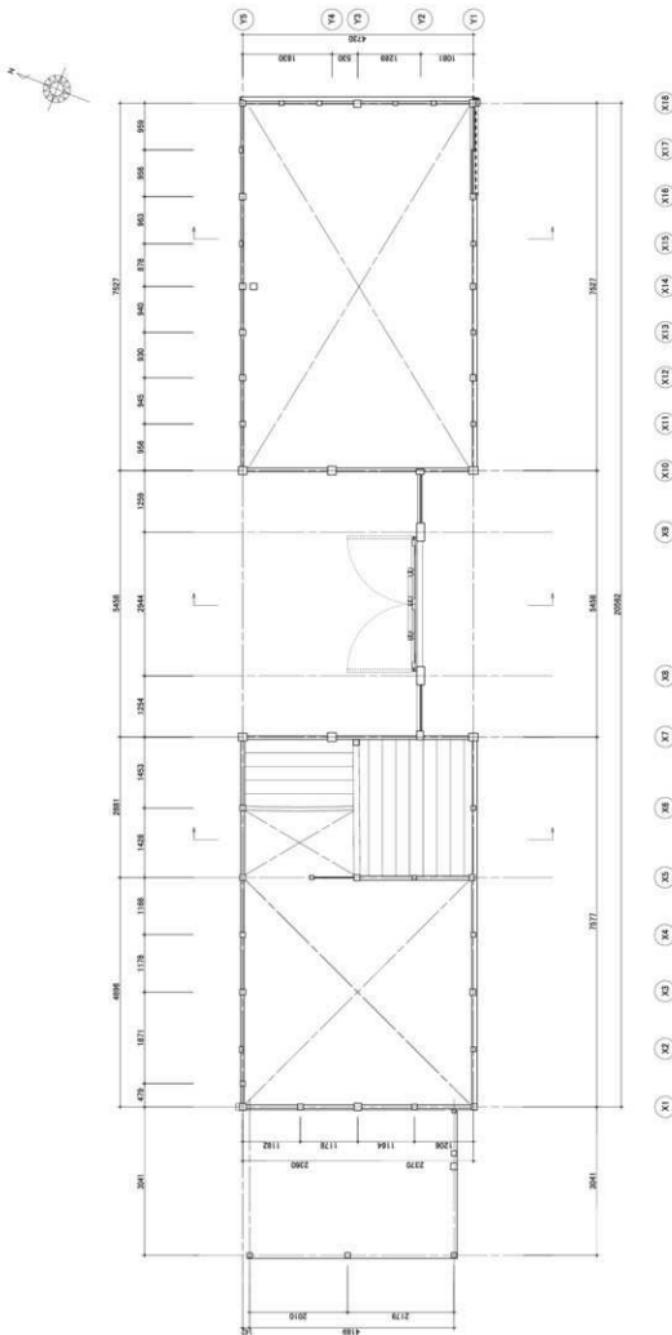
長屋門 修理前 2階平面図 S=1/100
